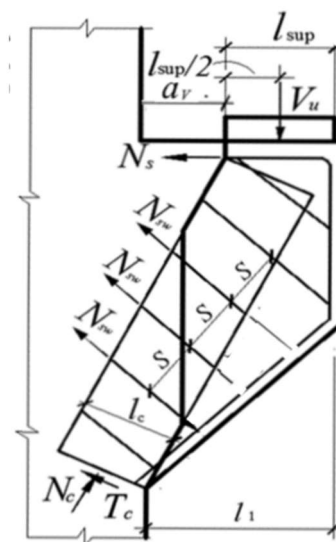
Розрахункова схема залізобетонної консолі при зрізі в межах
